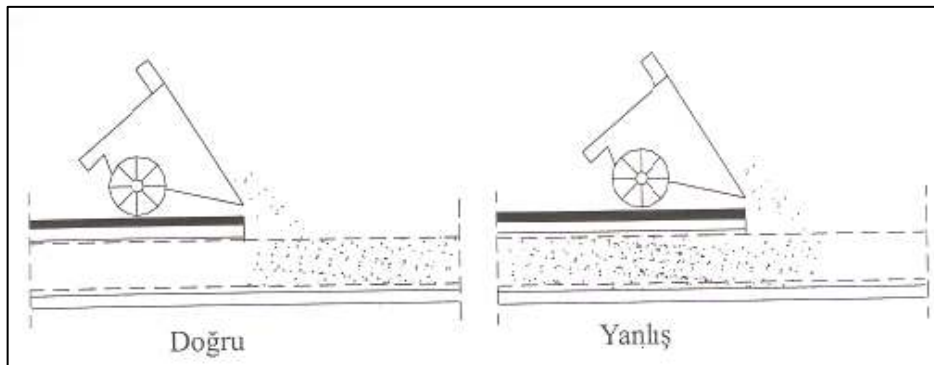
Meyilli Yüzeylerde Tabakalar Halinde Betonun Sıkıştırılması
